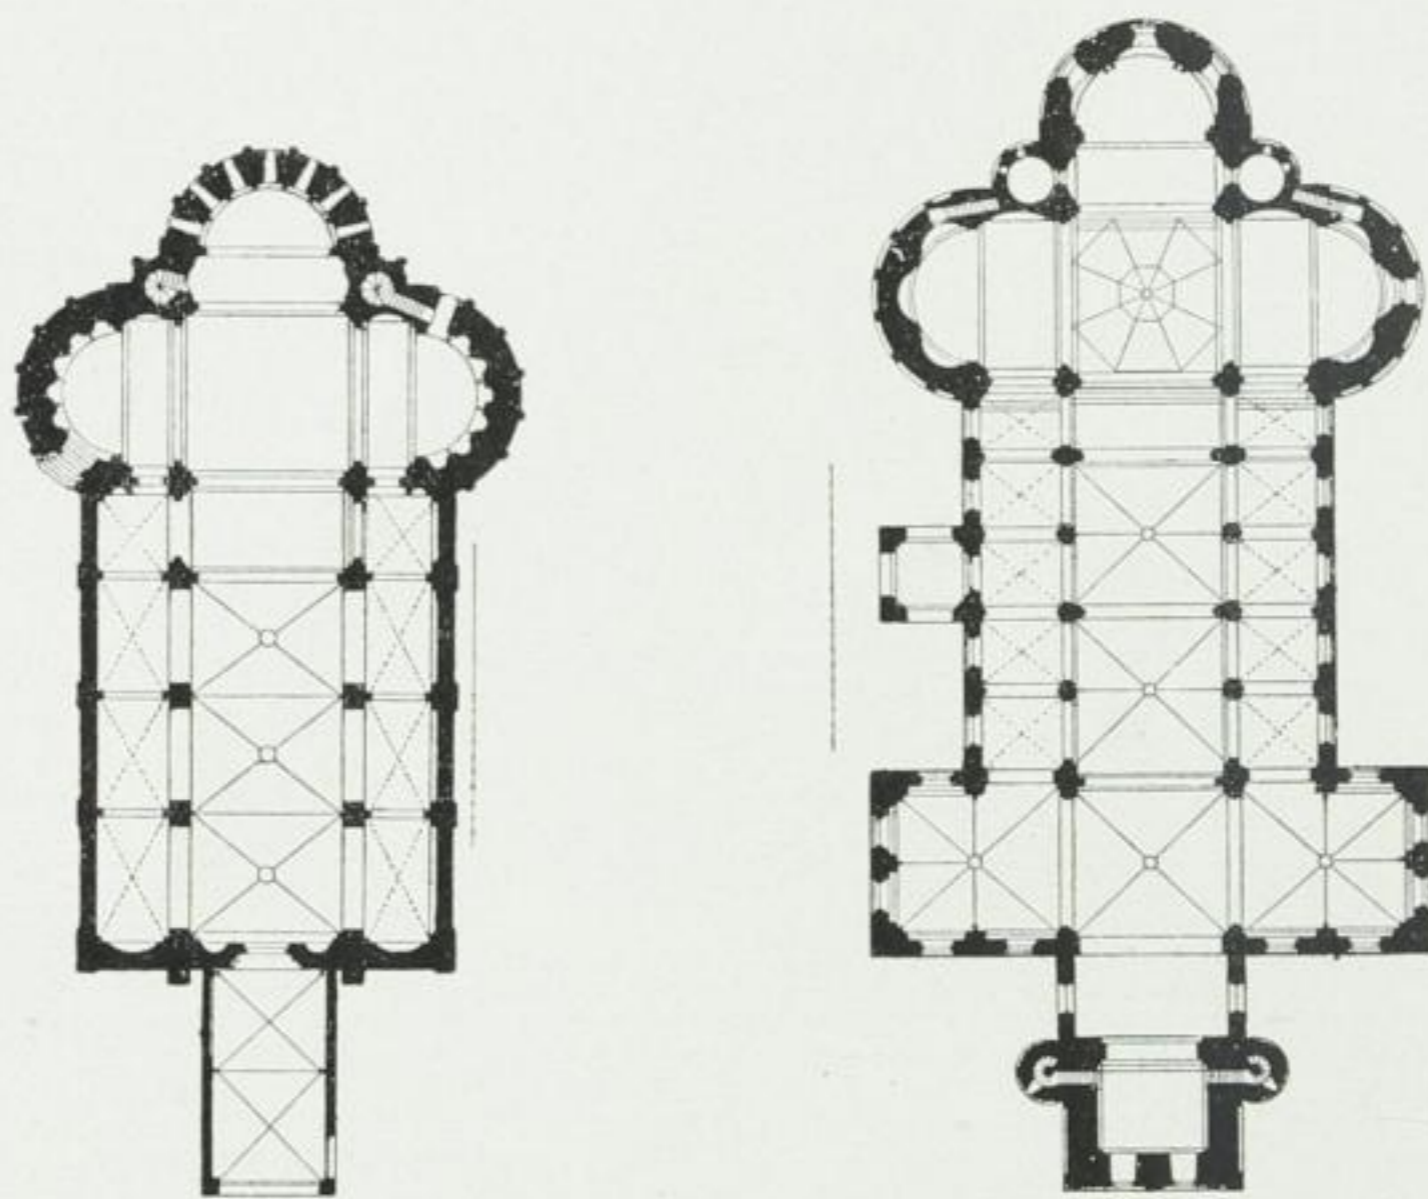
Grundrisse von Gr. St. Martin und St. Aposteln.
